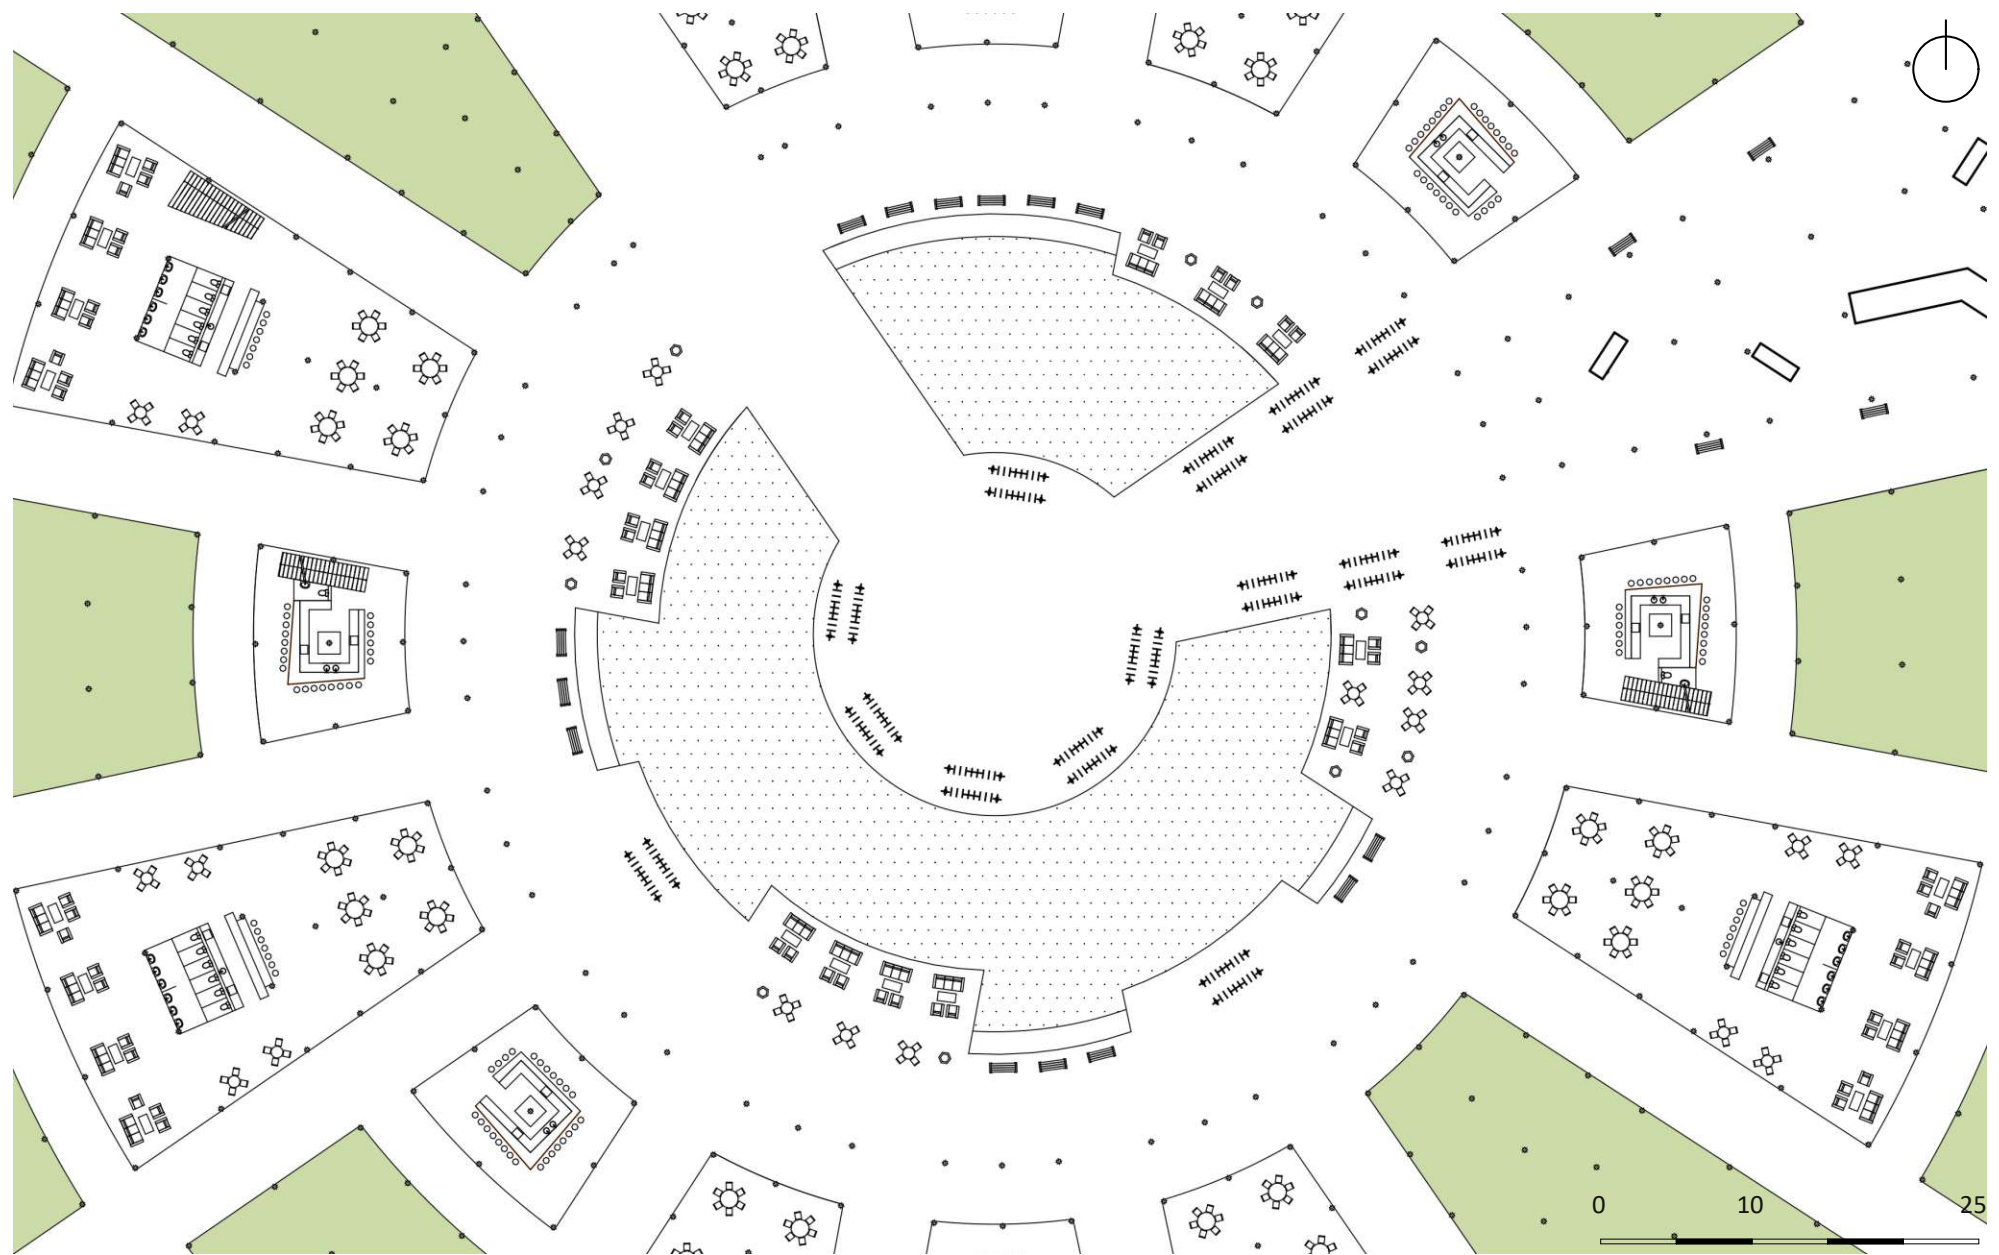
| Grundriss - Zentraler Innenhof
